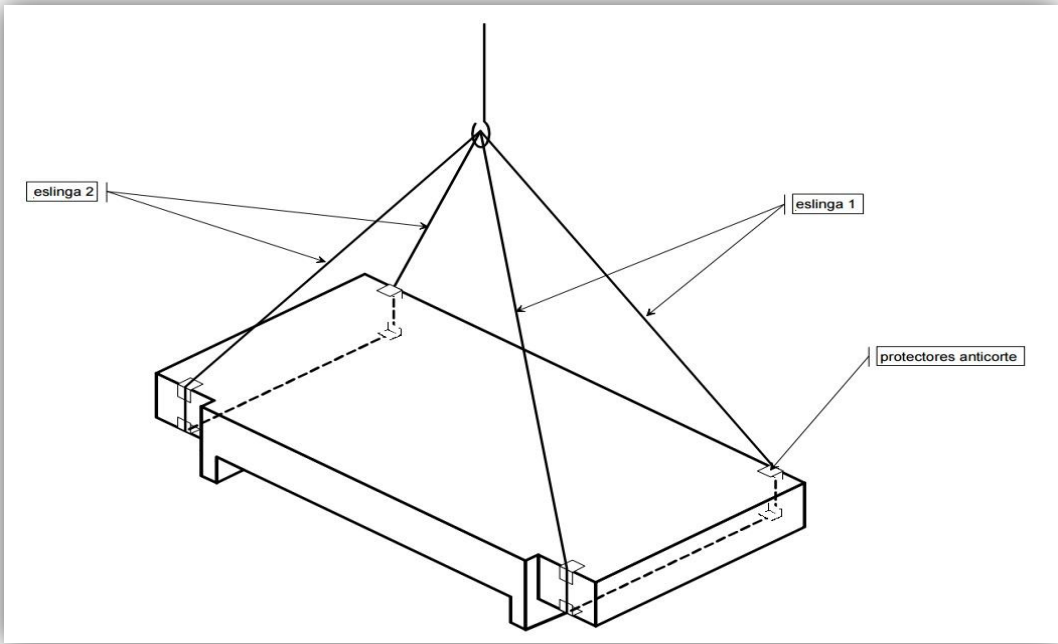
Colocación de las eslingas en la semi-cubierta
